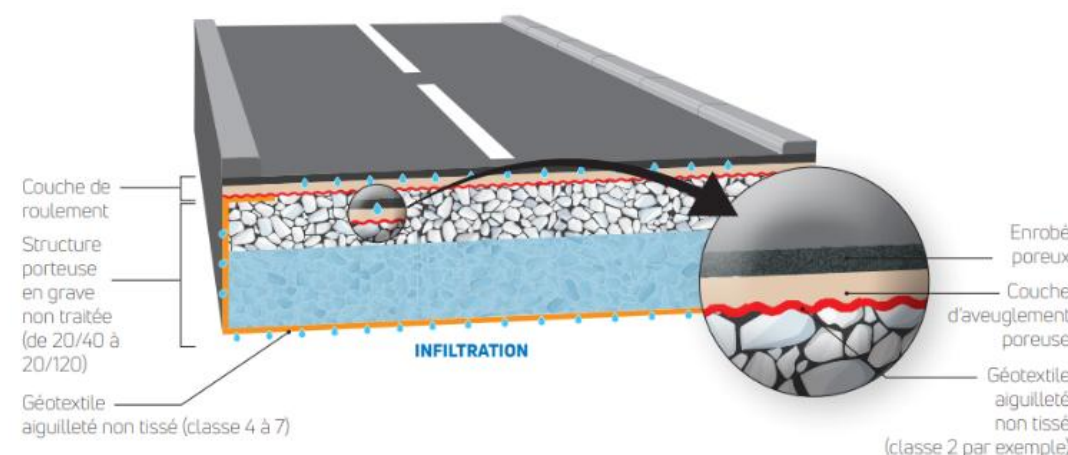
Proposition de chaussée poreuse infiltrante issue des fiches ADOPTA
